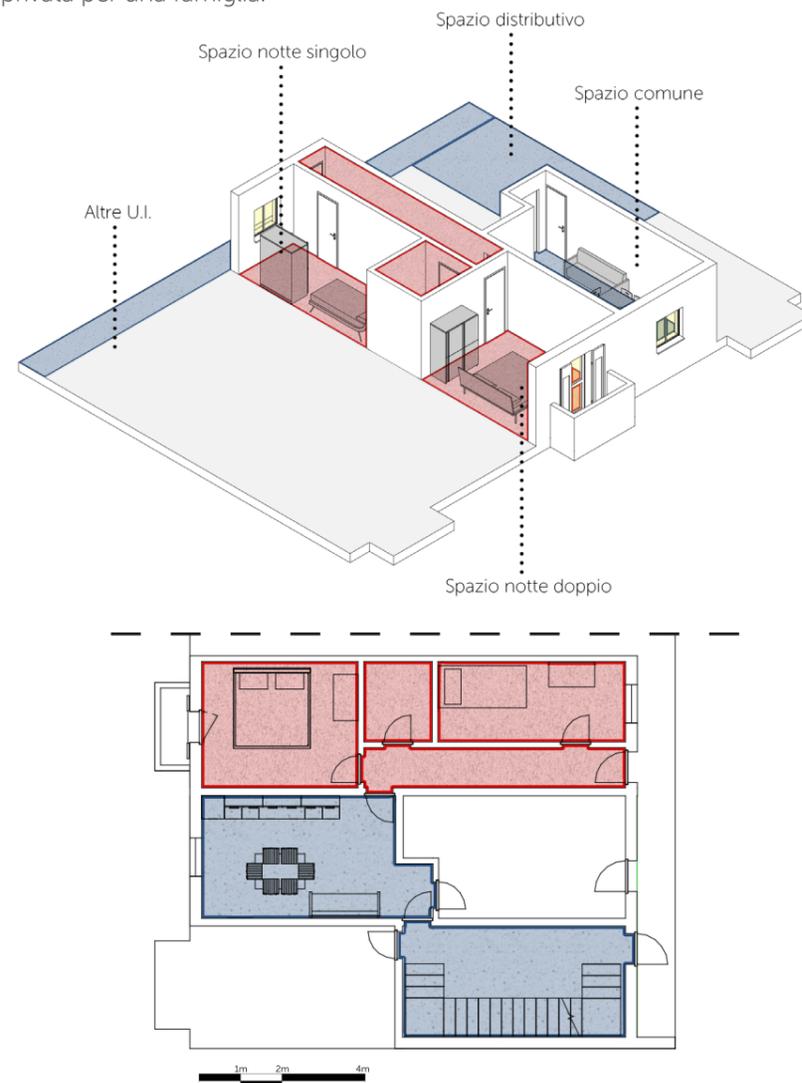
Vista 3D e pianta della disposizione interna dell'abitazione privata doppia
